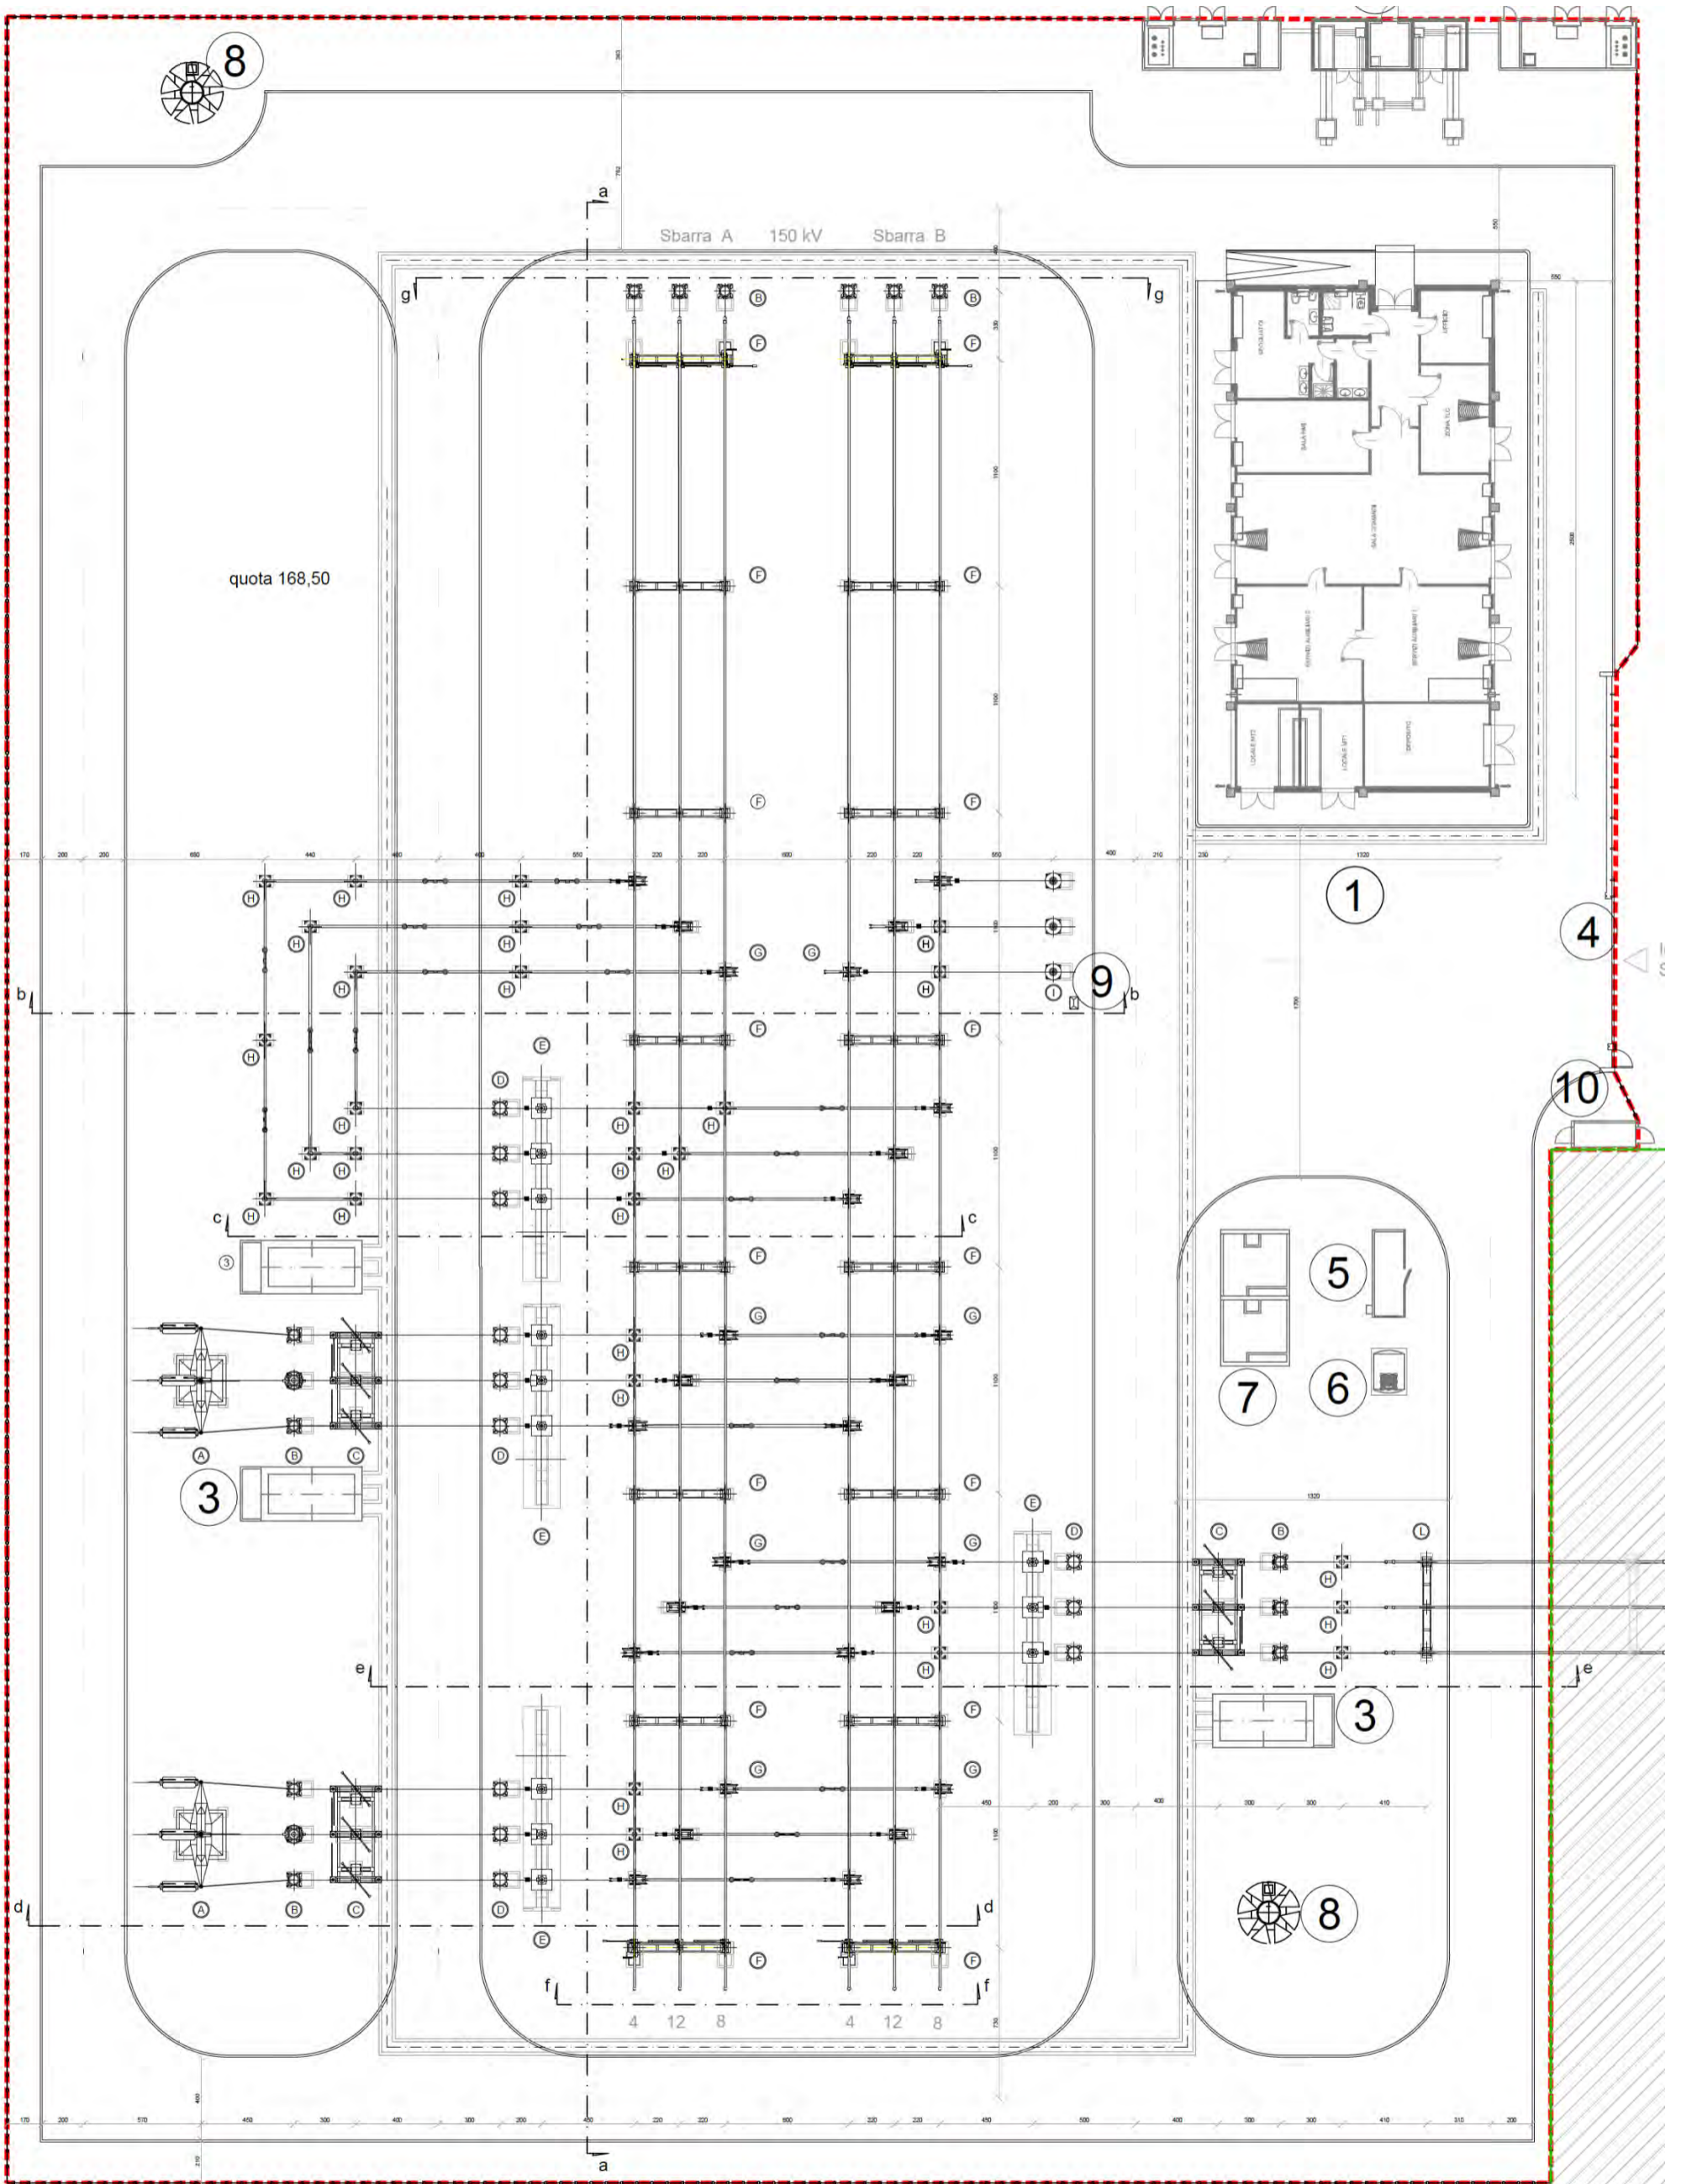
Planimetria elettromeccanica della Stazione Elettrica – dettaglio
